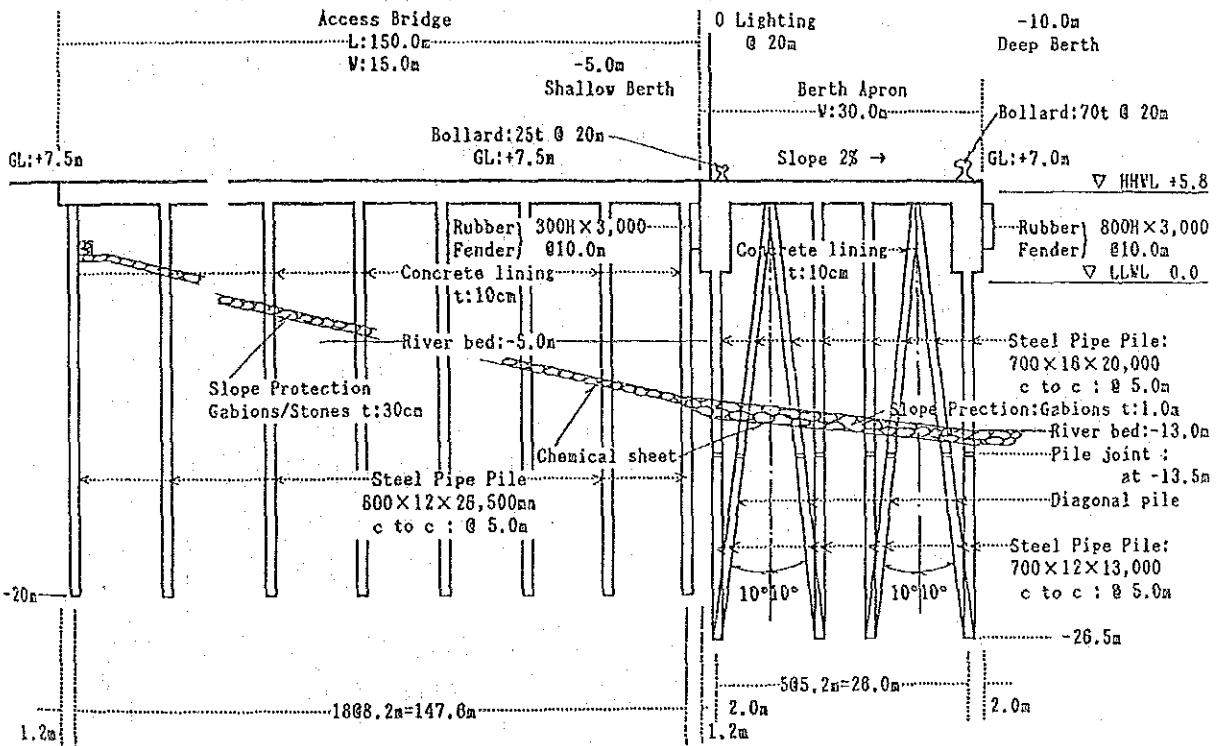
10m・-5m併用石炭埠頭標準断面図
